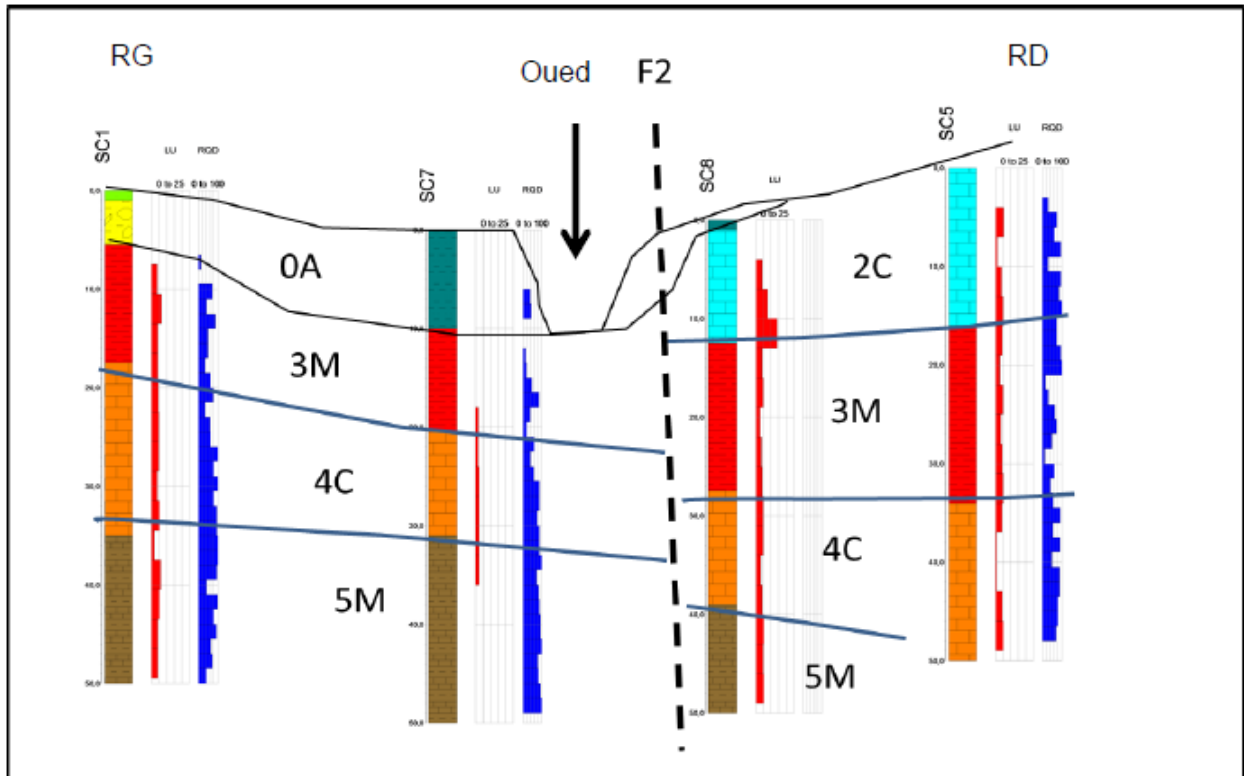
Coupe BB, rive gauche-rive droite au centre du futur ouvrage en béton
